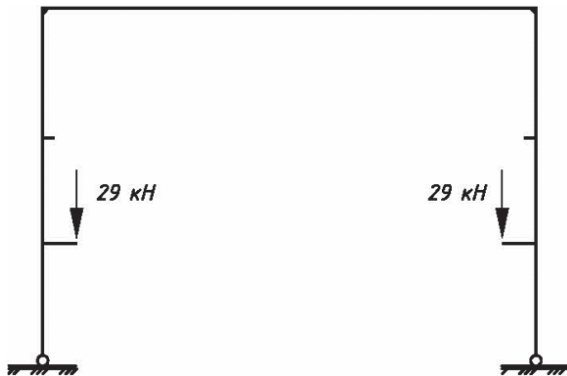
Схема нагрузки собственным весом кирпичной кладки под сводом.
